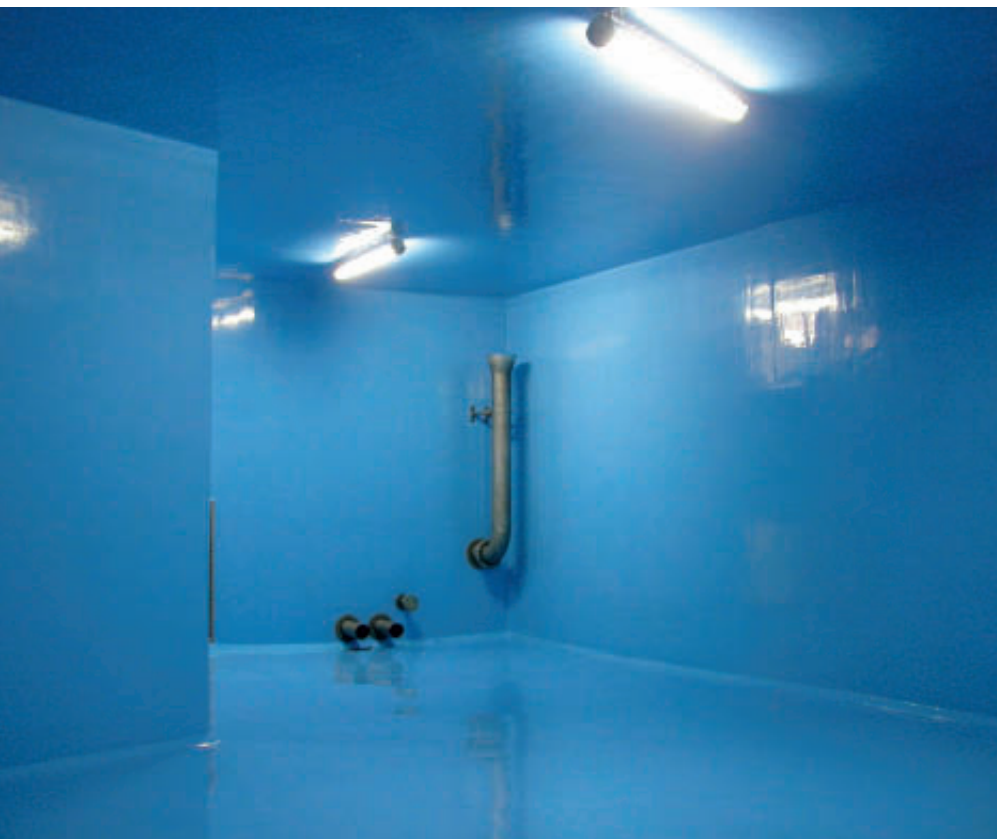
Glatte, sich spiegelnde Oberfläche eines mit Epoxydharz beschichteten Betonbehälters
